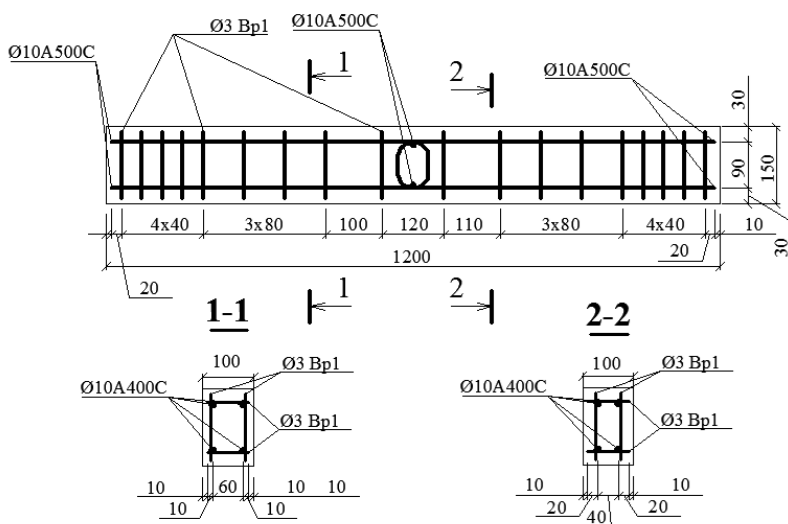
Схема армирования опытных железобетонных балок с петлевыми стыками, расположенными в середине пролета.
